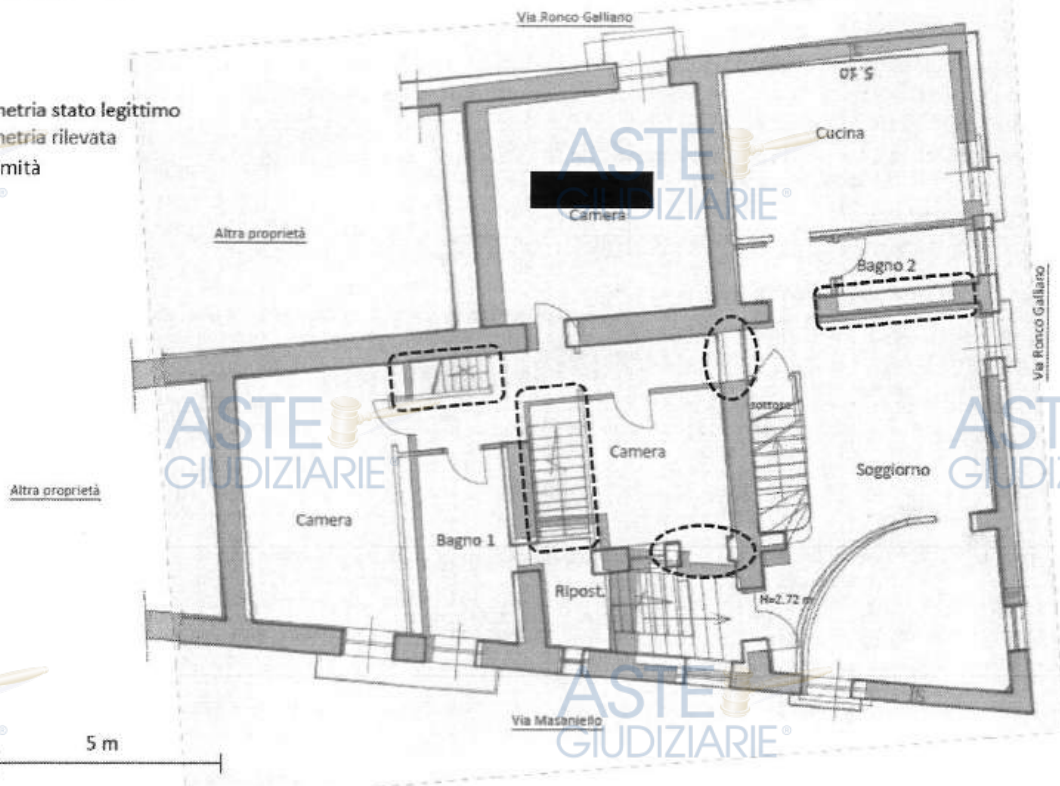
Sovrapposizione stato reale dei luoghi e progetto autorizzato - Planimetria abitazione - piano 1°
